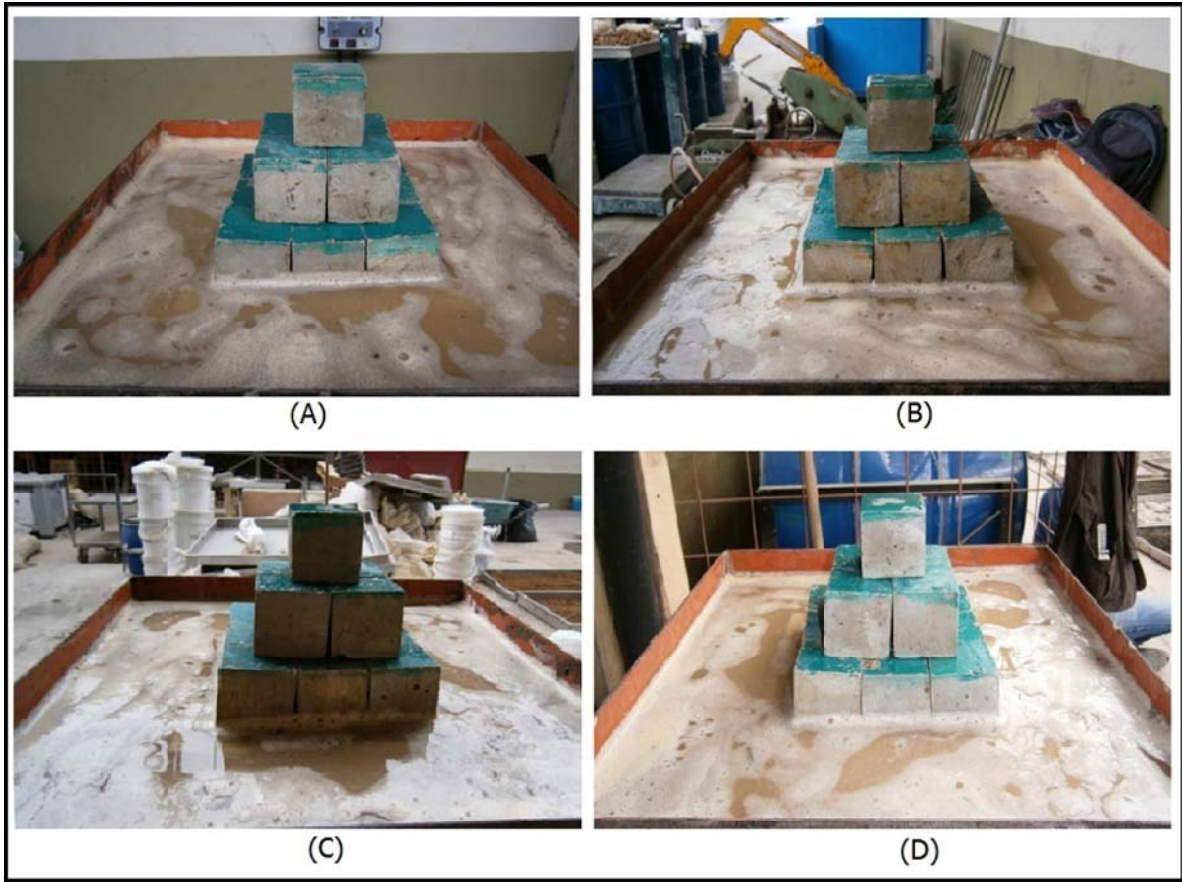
Resultado del modelo a escala combinación 15/85. (A) Fachada norte, (B) fachada este, (C) fachada sur, (D) fachada oeste
